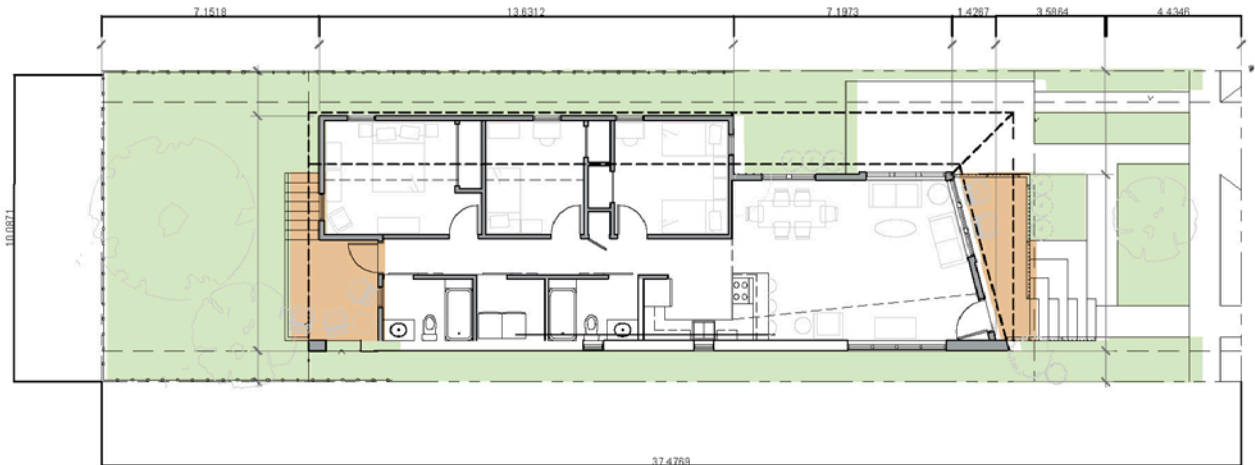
Plantado del proyecto en el terreno destinado para el proyecto
